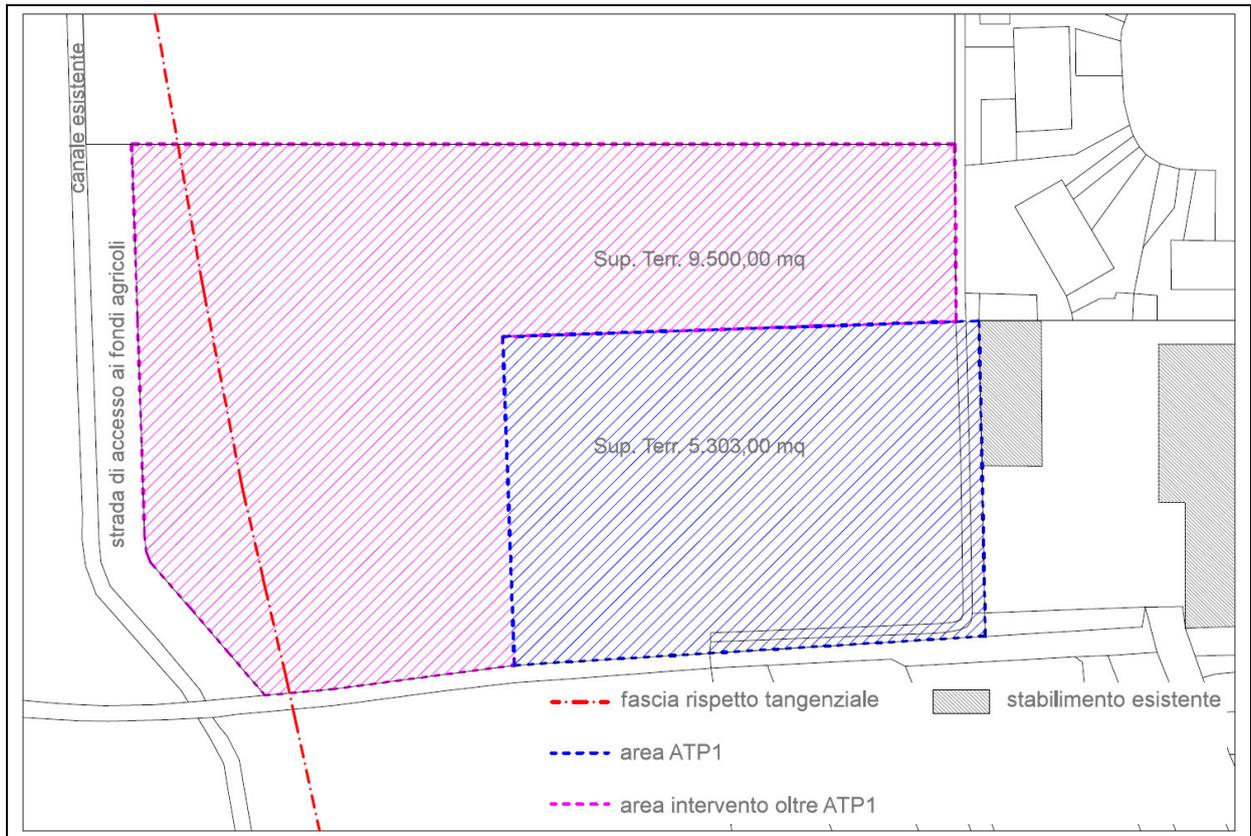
SUAP in Variante: planimetria area di intervento (fuori scala).
